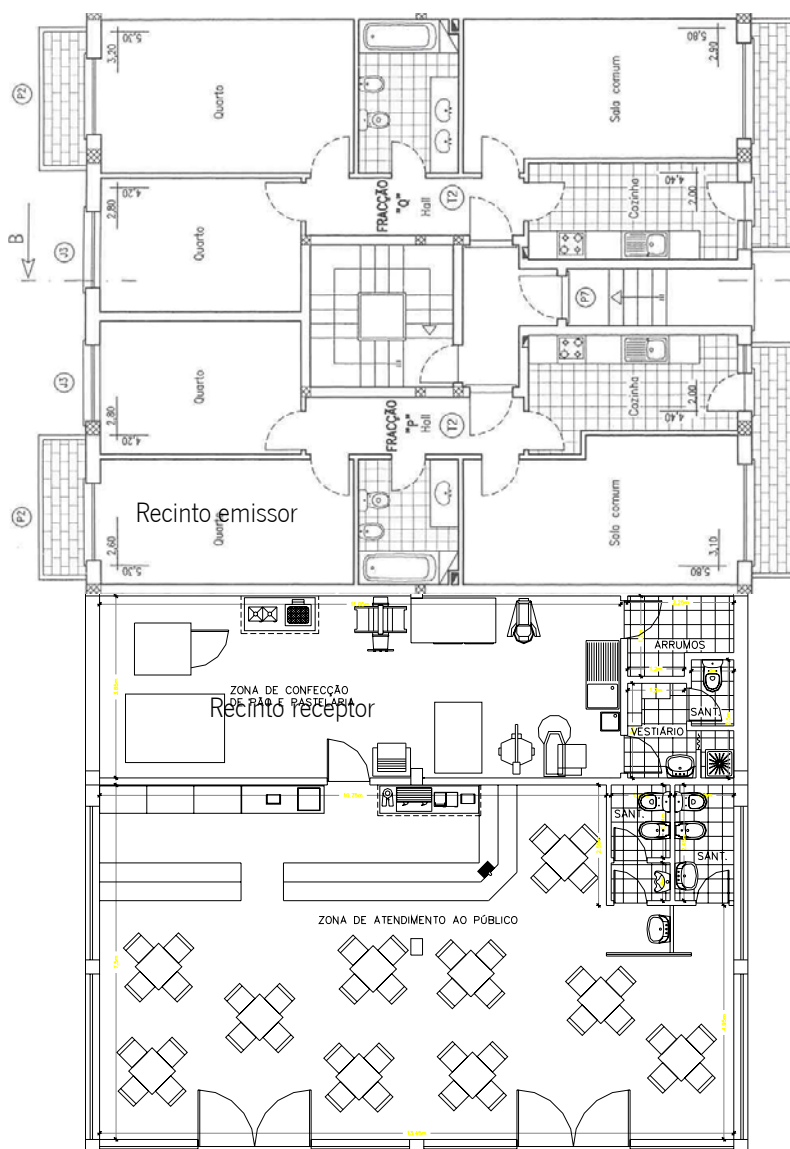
Planta do recinto emissor e do recinto receptor do ensaio de avaliação do isolamento da parede interior Parl2
